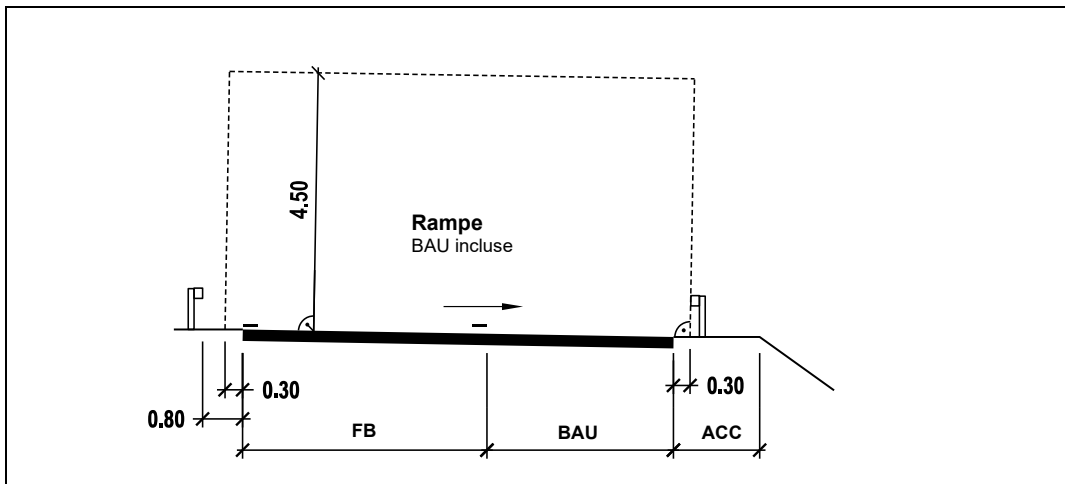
Gabarit d'espace libre de la chaussée d'une rampe, BAU incluse
